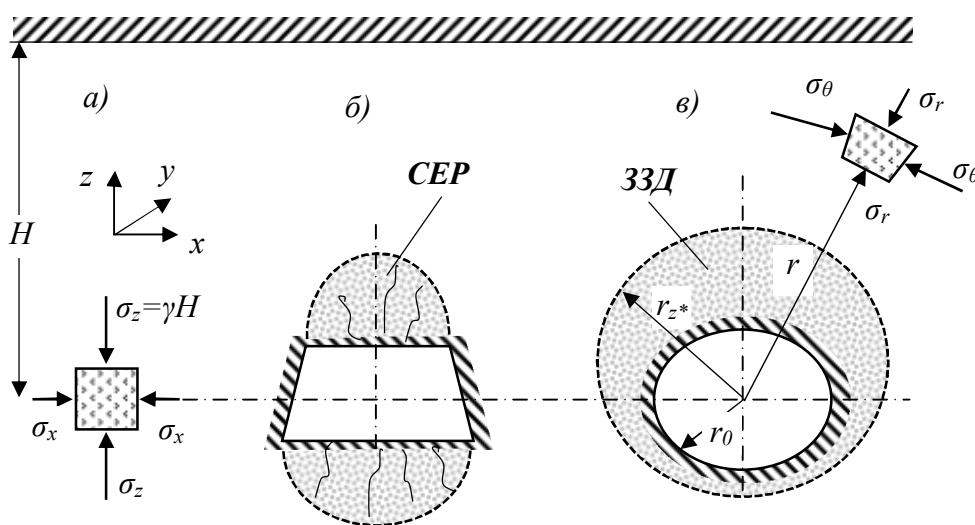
Расчетные схемы ПГД вокруг выработки:
